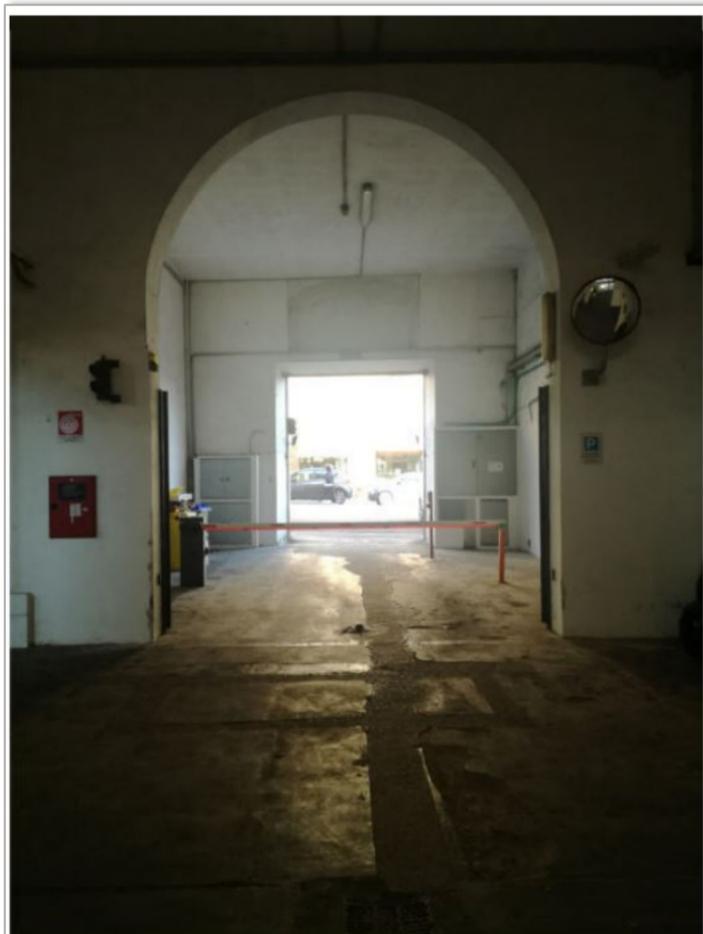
INGRESSO PRINCIPALE GARAGE
